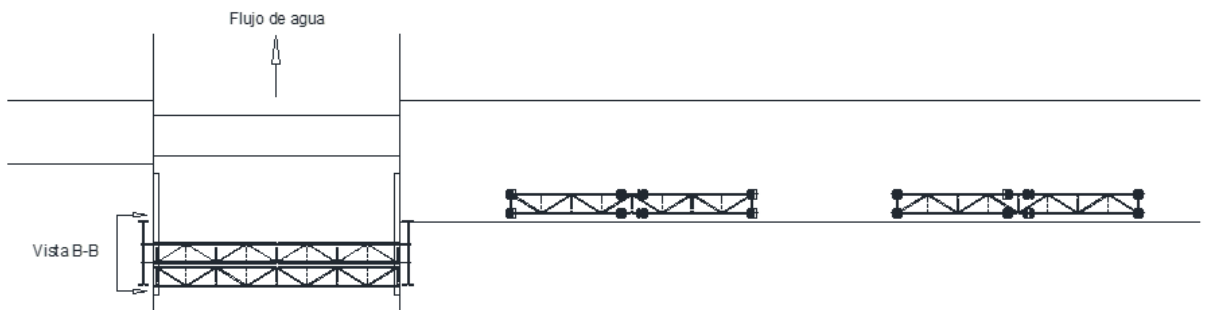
Segundo par de vigas metálicas ubicados en su posición final
